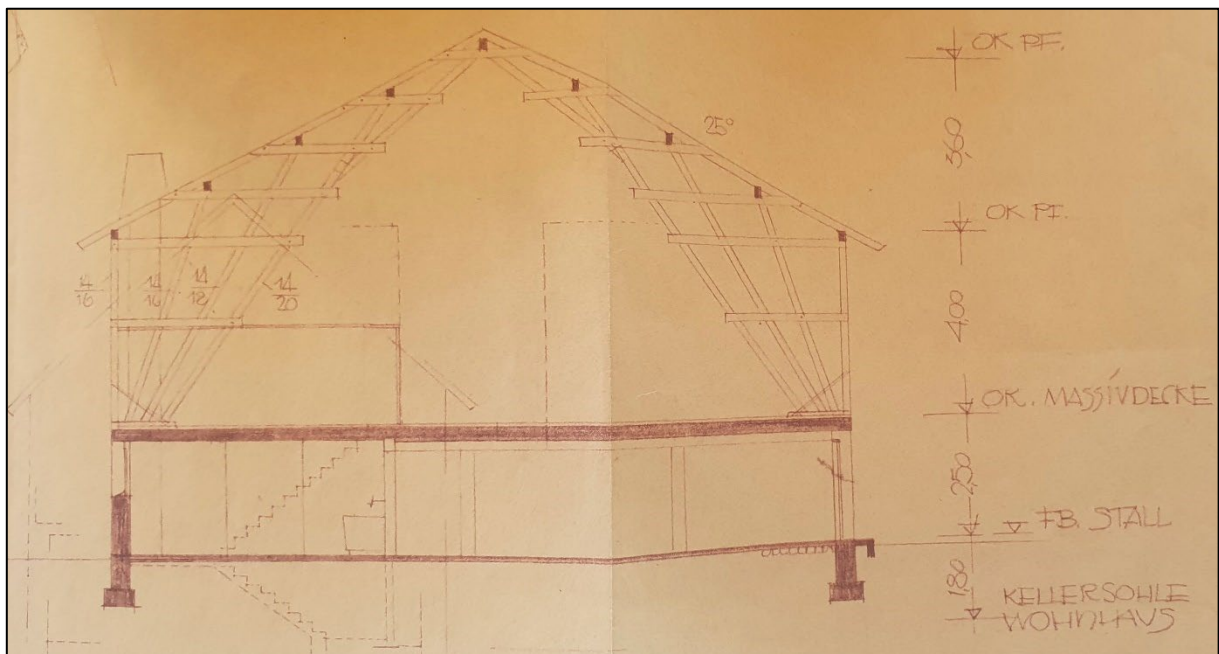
Auszug aus den Einreichplänen 1954; im gemauerten Untergeschoß ist der Stall mit Massivdecke, darüber Tenne und Heubergeraum in Holzriegelbau mit einfacher Außenverschalung errichtet worden.
